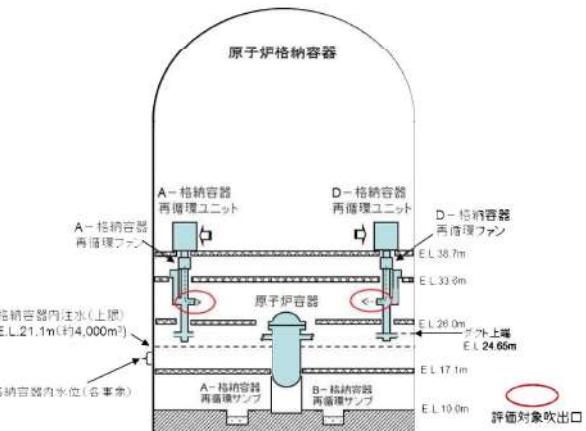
格納容器再循環ユニット配置概要図 (原子炉格納容器断面図)
